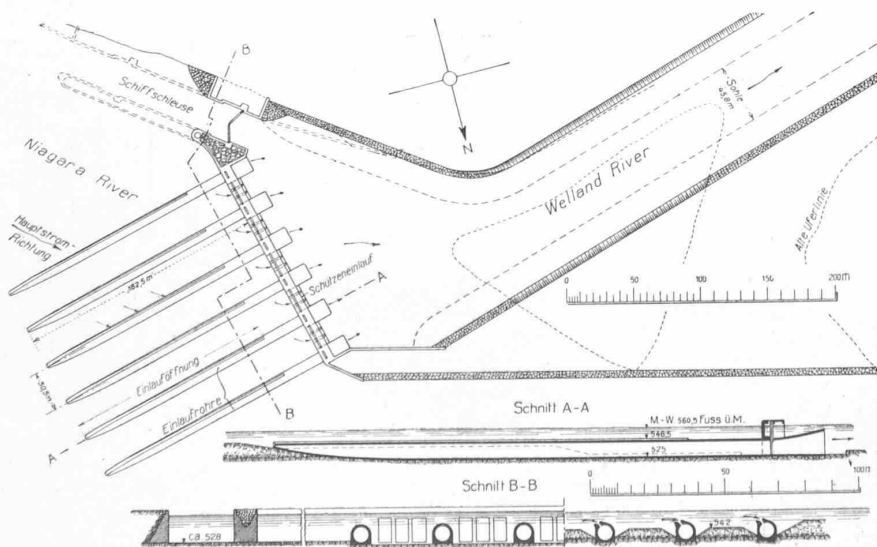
Kanaleinlauf in Chippawa. — Grundriss 1:5000, Schnitte 1:2500.
